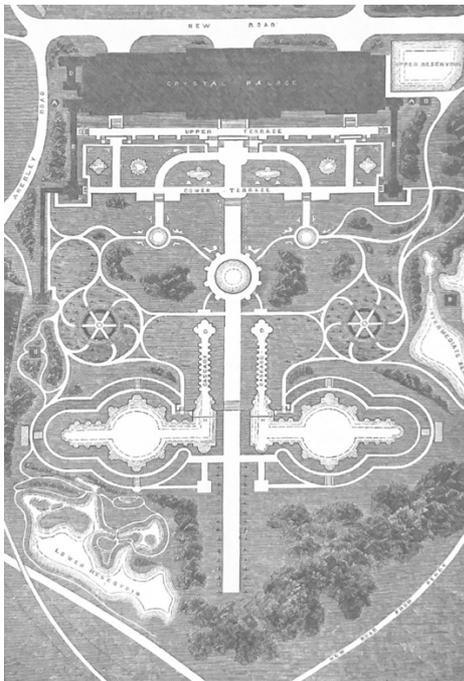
Lageplan Crystal Palace und Hyde Park
